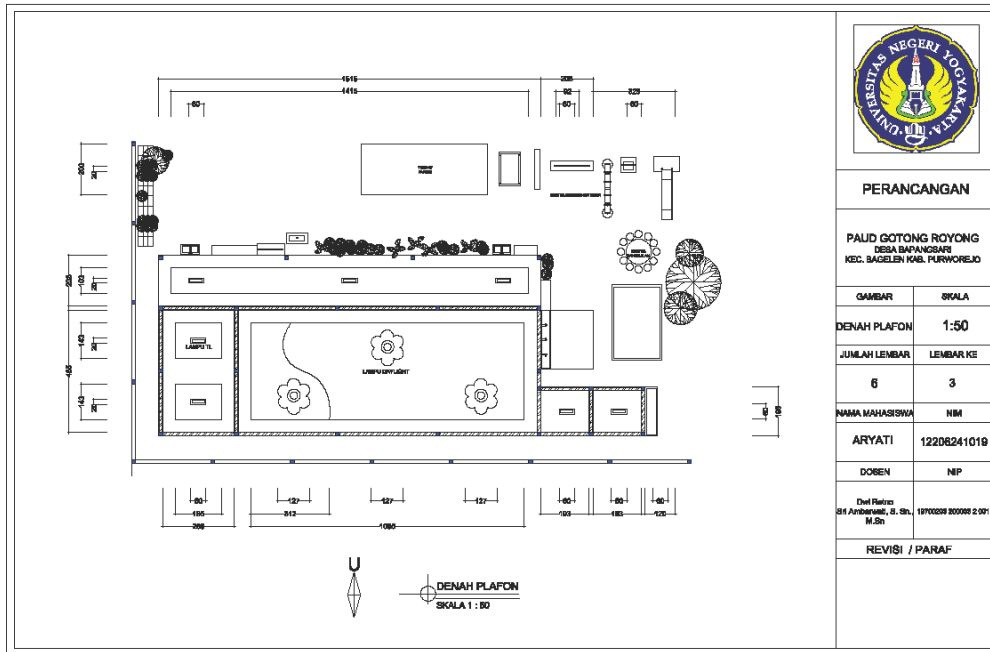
Denah Perancangan Ruang PAUD Setelah Revisi
